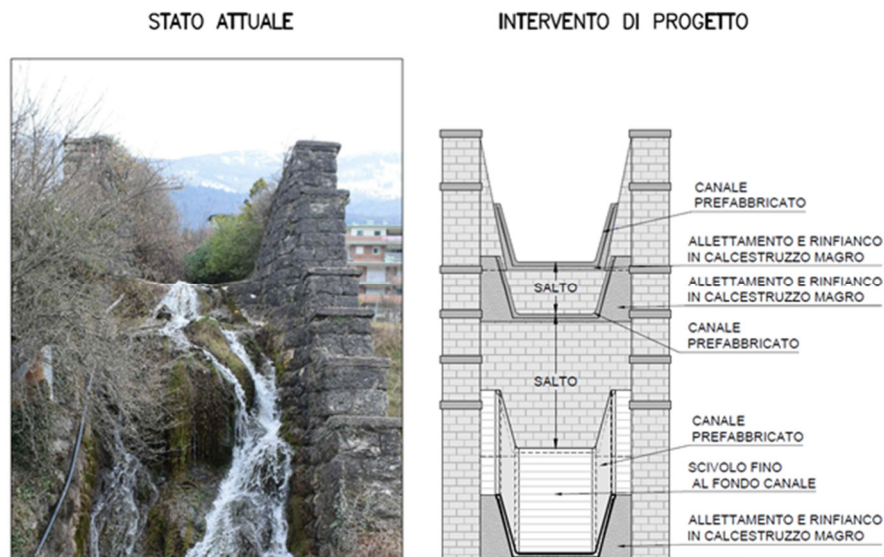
Ponte Canale Rio Valnigra: Stato attuale e stato di progetto.
